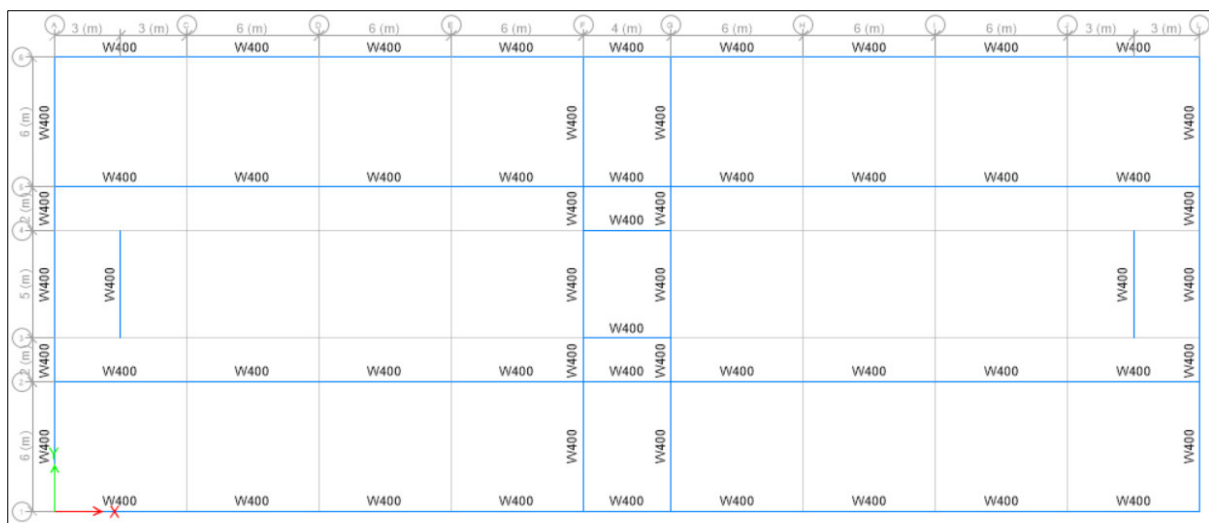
Distribución de vigas principales W 400 en el piso 1.
